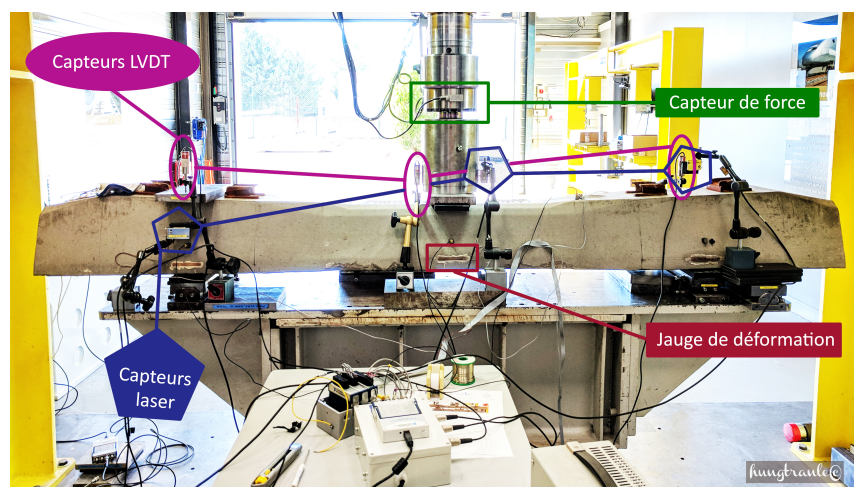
Dispositif d'essai de flexion 3 points d'une traverse (photo source : *hungtranle*©)
